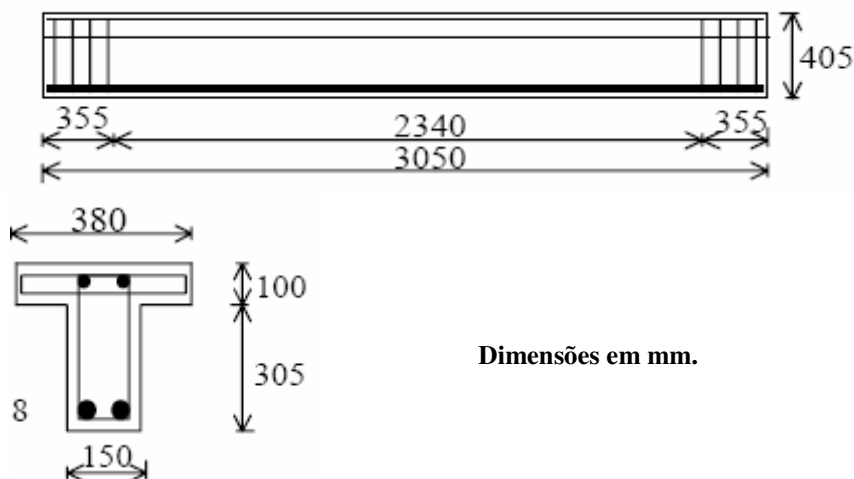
Armação das viga ensaiada por Kalifa *et alii* (1999).
